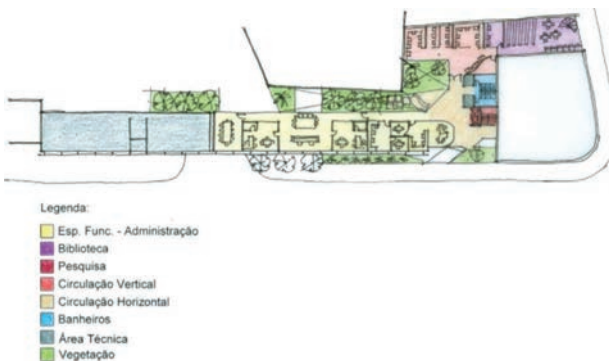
Planta do Primeiro Pavimento do novo bloco anexo
